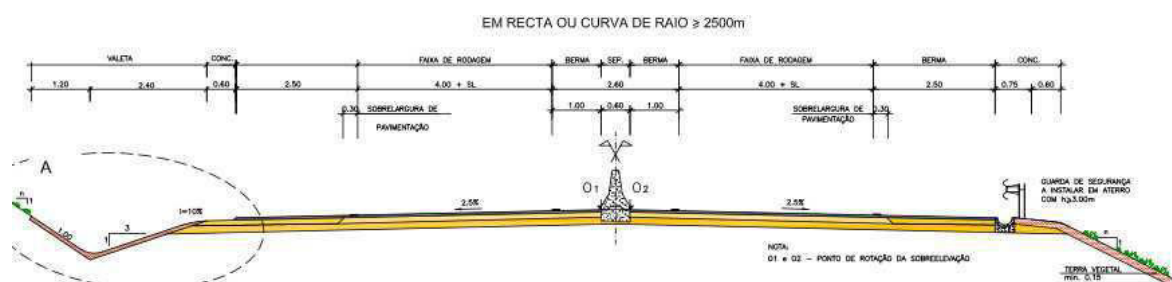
Perfil Transversal Tipo – zona dos nós de ligação [3]
